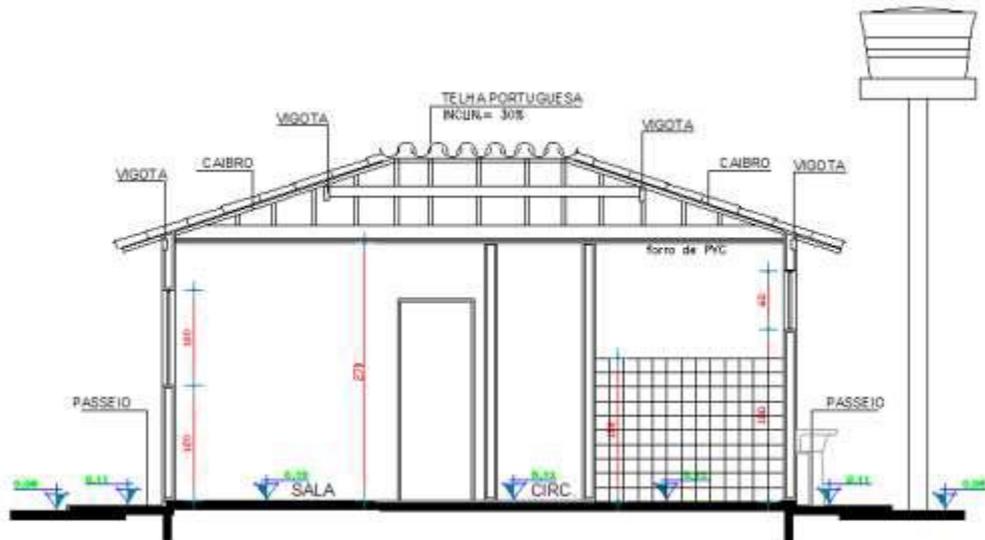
Detalhe do projeto de alvenaria estrutural
